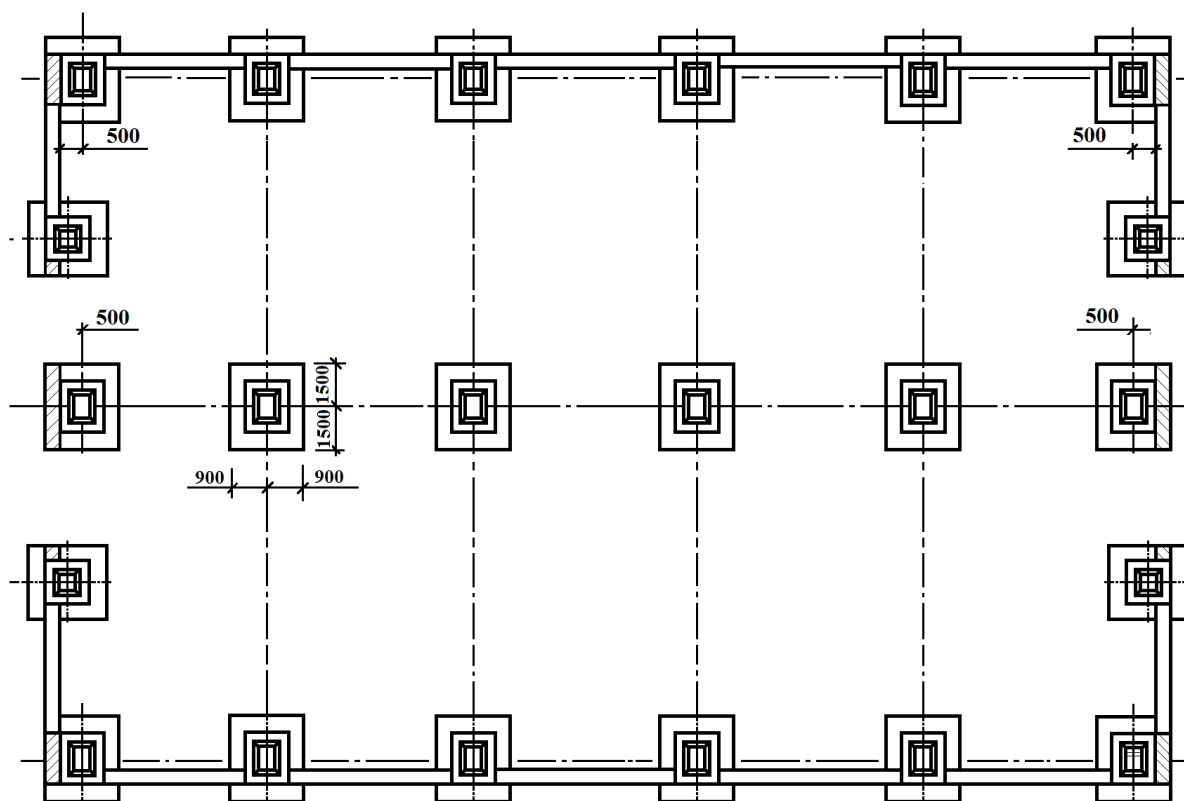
Укладка фундаментных балок и устройство монолитных участков
